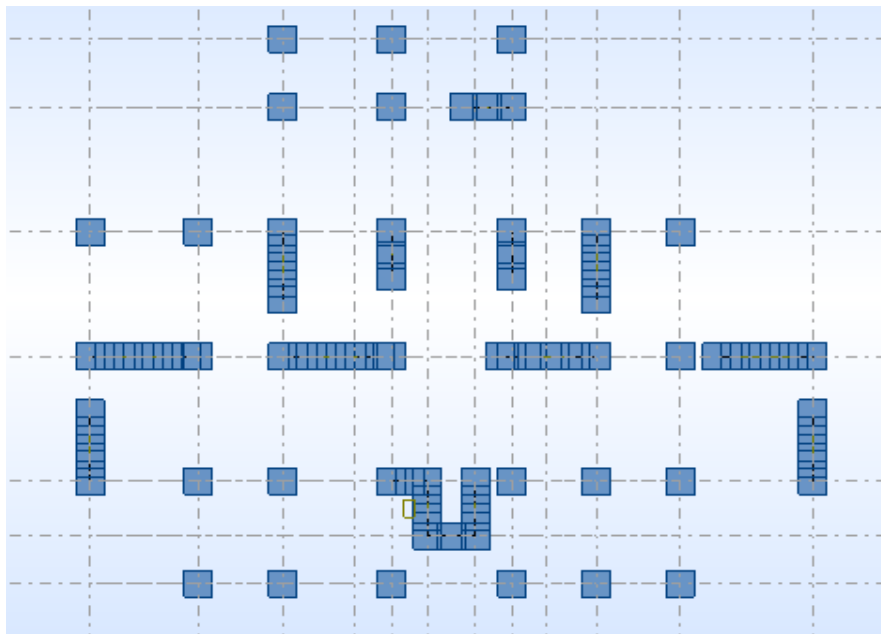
Disposition des voiles de la 2^{ème} proposition
